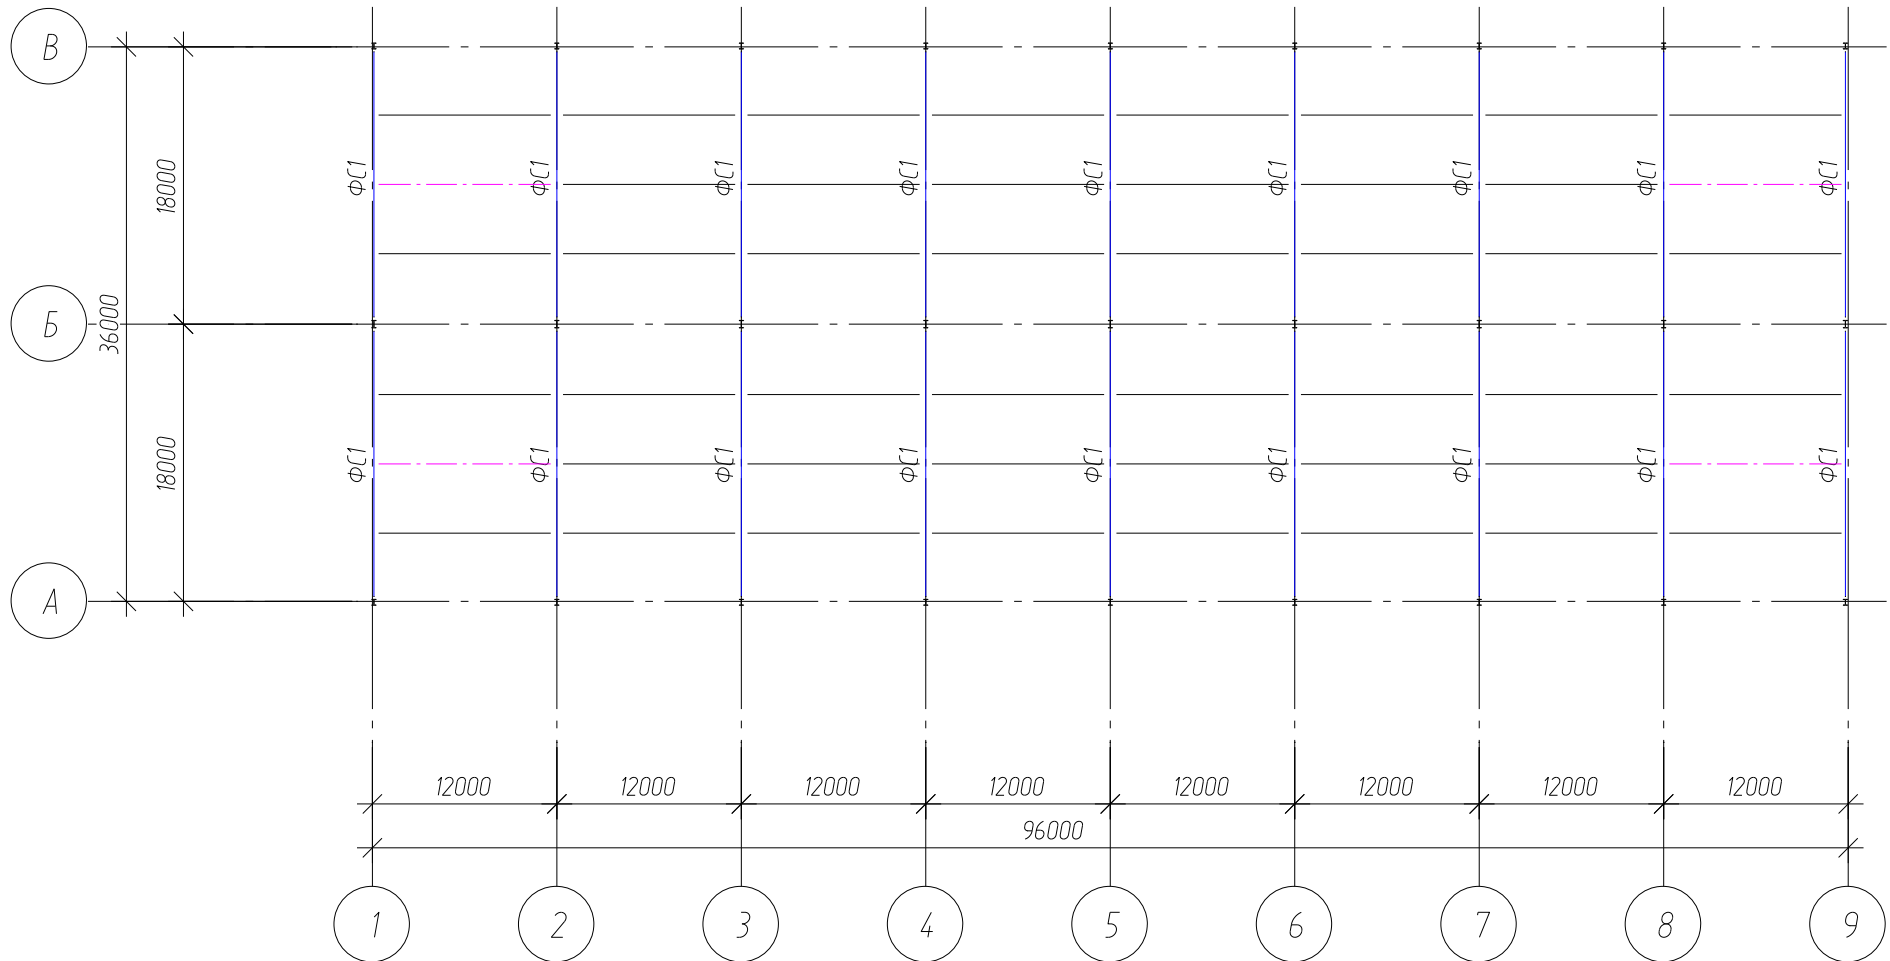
«Схема расположения связей и распорок по нижним поясам ферм» [14]
